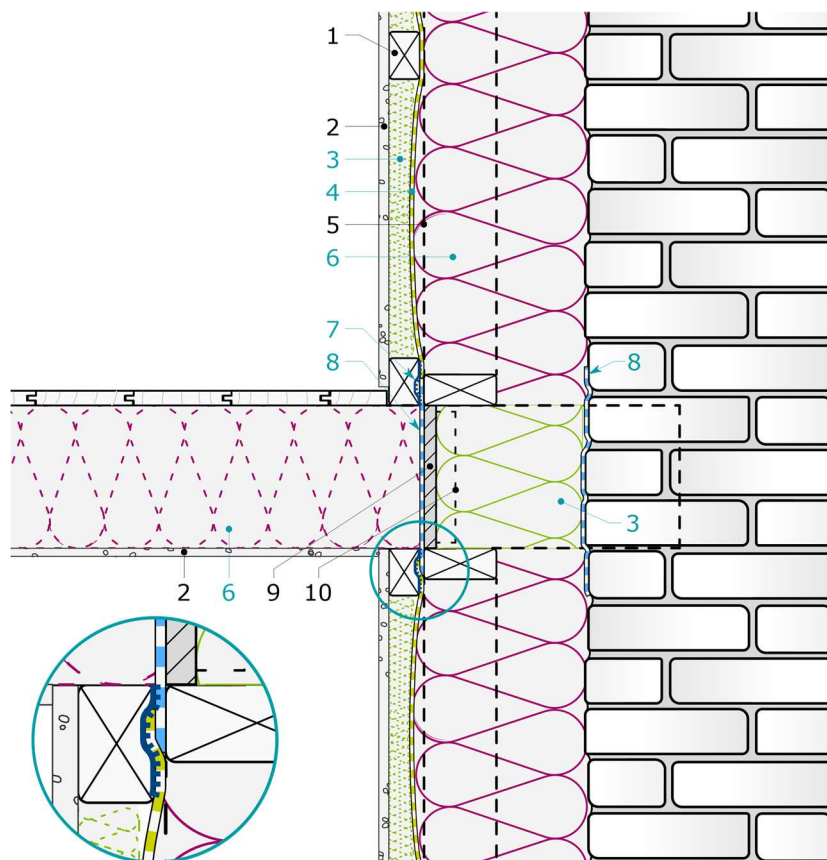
Coupe verticale mur – plancher d'étage en bois – solution de base
